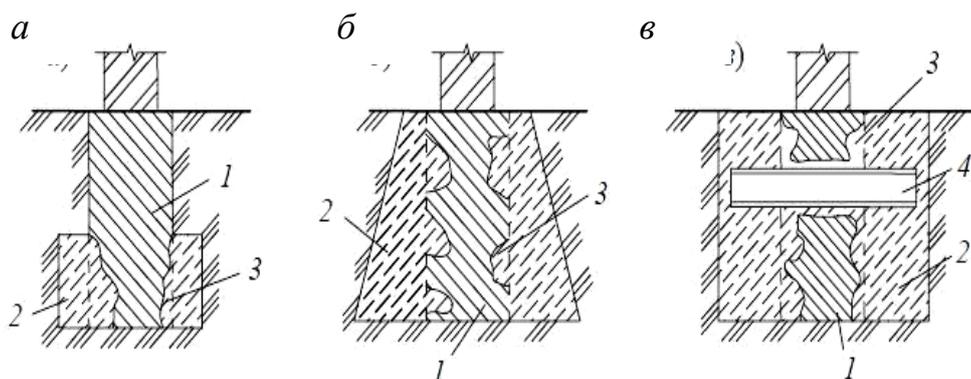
Схемы усиления ленточных фундаментов бетонными обоймами: *а* – обоймой у подошвы; *б, в* – трапецеидальной и прямоугольной, установленными на всю высоту тела фундамента; *1* – фундамент; *2* – обойма; *3* – штрабы; *4* – балка усиления
